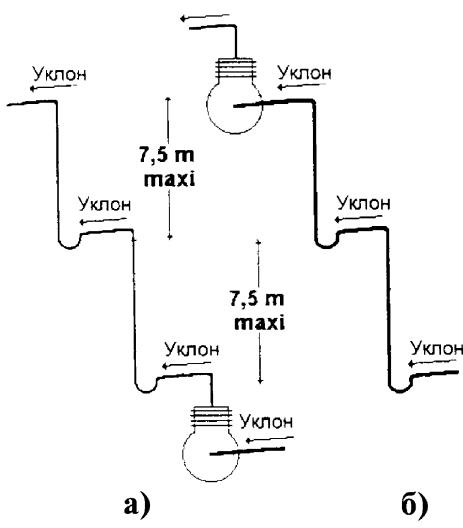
Схема установки маслоподъемных петель на восходящих участках трубопроводов длиной более 7,5 метров: а) нагнетательный трубопровод, уклон не менее 12 мм на 1 м, б) всасывающий трубопровод, уклон не менее 12 мм на 1 м.
